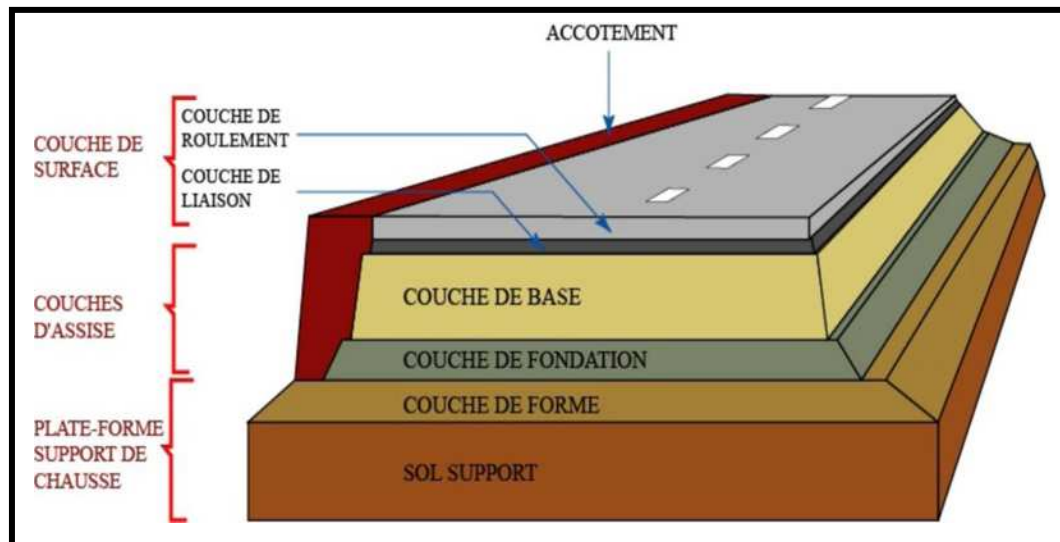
Profil type d'une chaussée (Ben Ouakhir, 2015)
